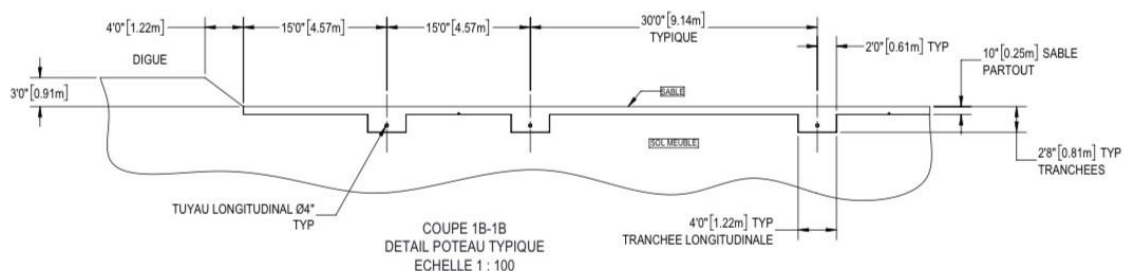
Coupe latérale du design souterrain des substrat et des tranchées de drainage
